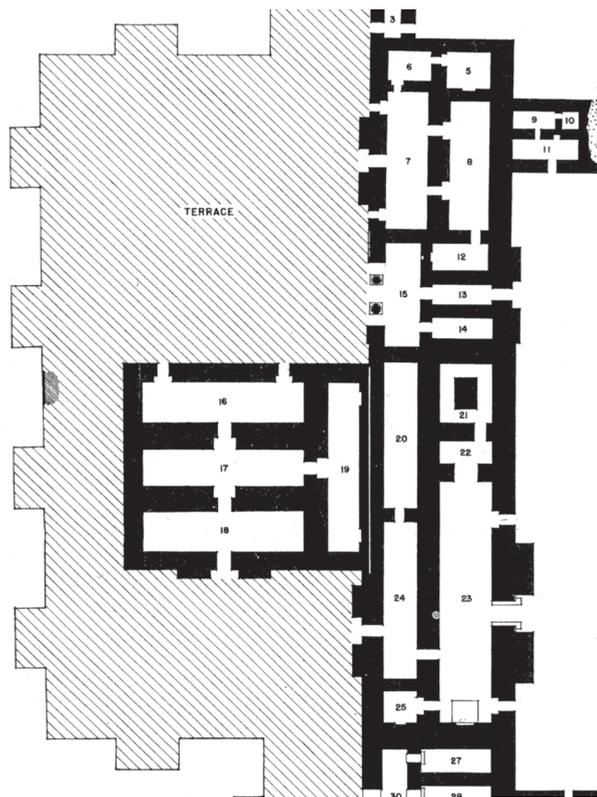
Plan des Palastes F in Dūr-Šarrukēn (aus: HEINRICH 1984: 170, Abb. 106)
